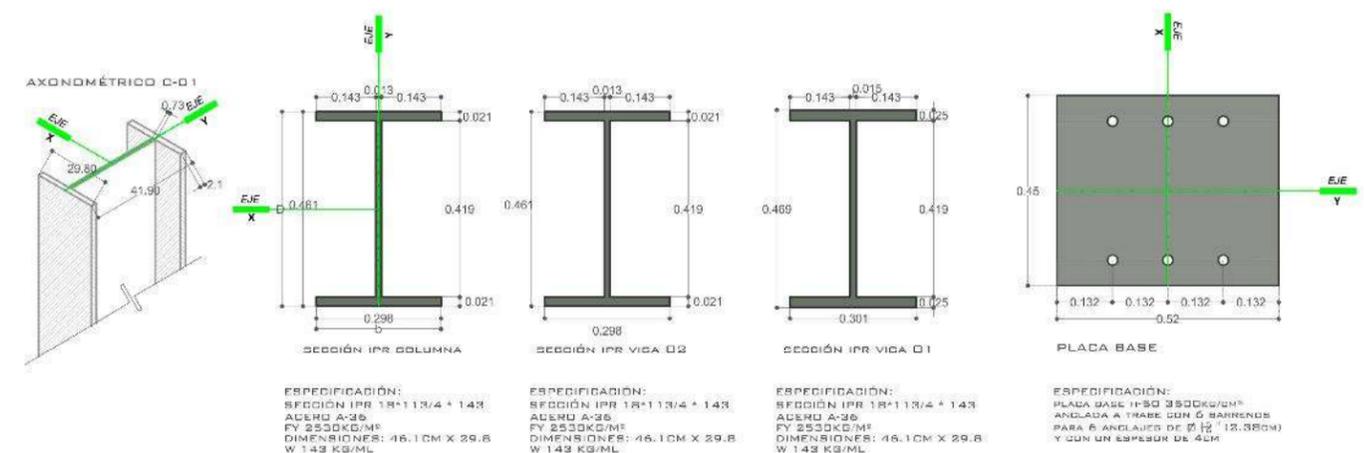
Detalle de Vigas IPR y columna IPR dibujada y editada por el autor. Software AutoCad+Photoshop
